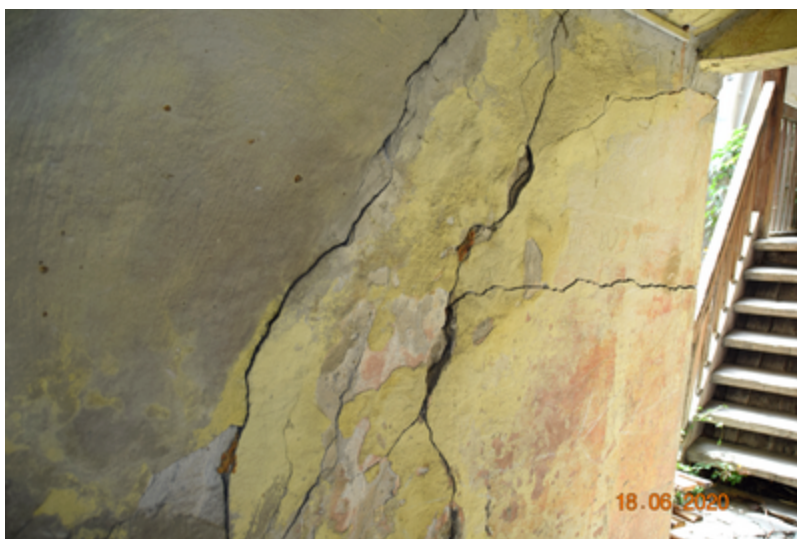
Elewacja południowa - pionowe zarysowanie
